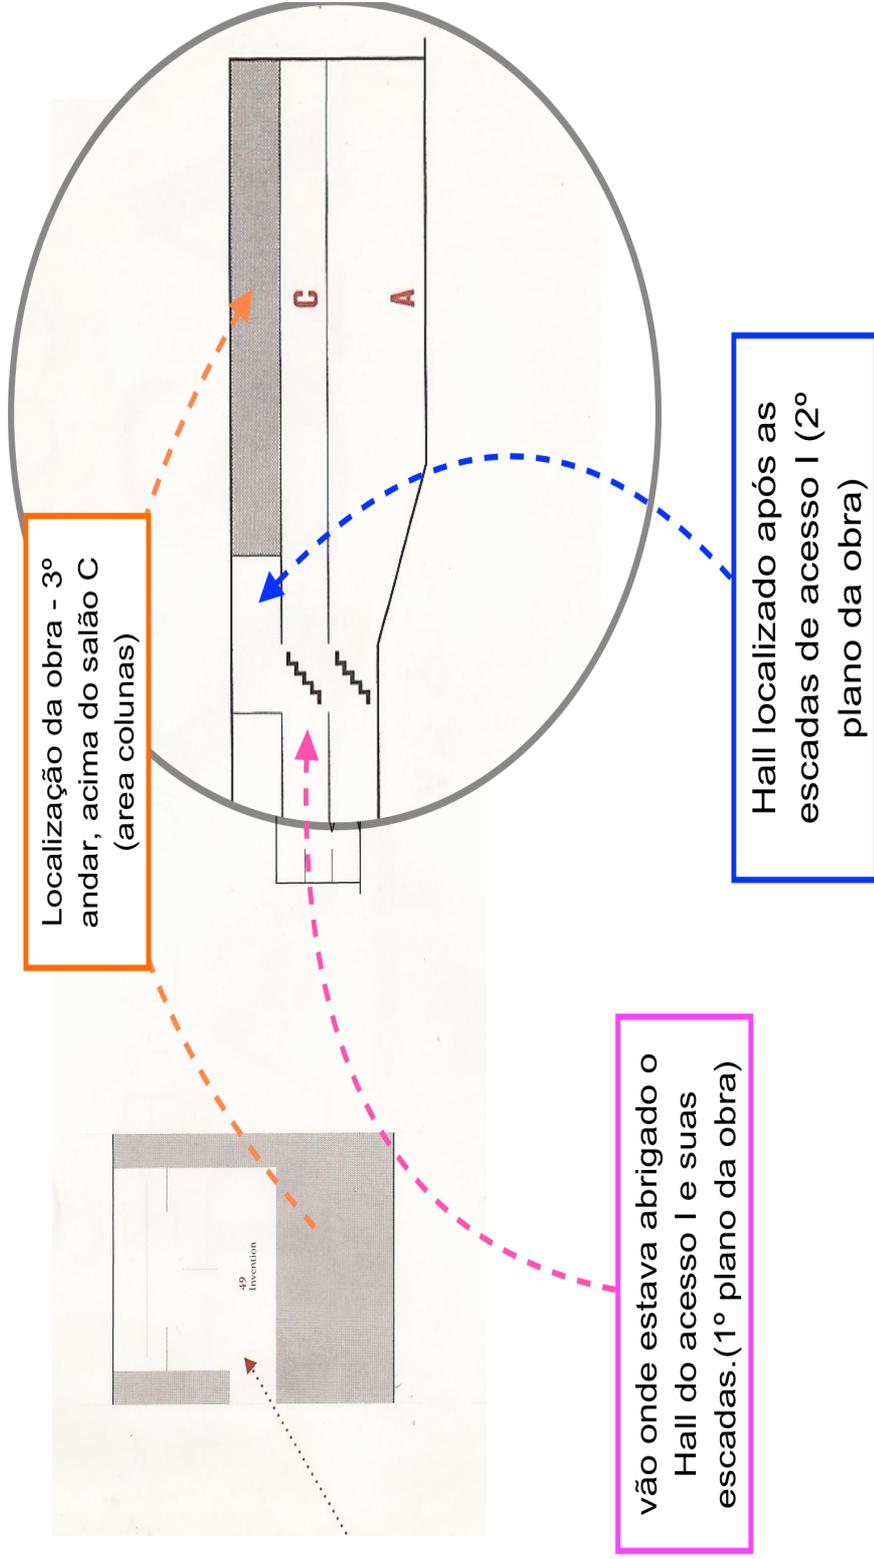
Detalhes sobre *Invention* na exposição pelas plantas baixa e de corte
